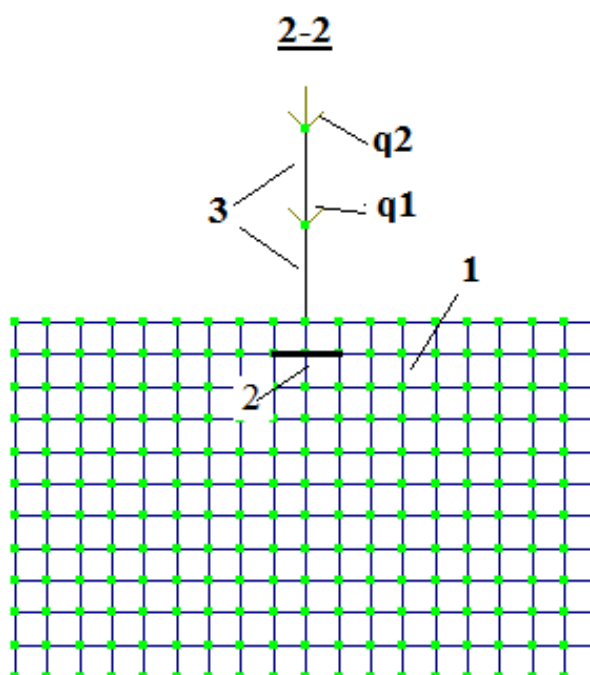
Розрахункова схема. Вихідний стан. Розріз по 2-2. 1 – основа; 2 – фундаменти; 3 – рамна конструкція
